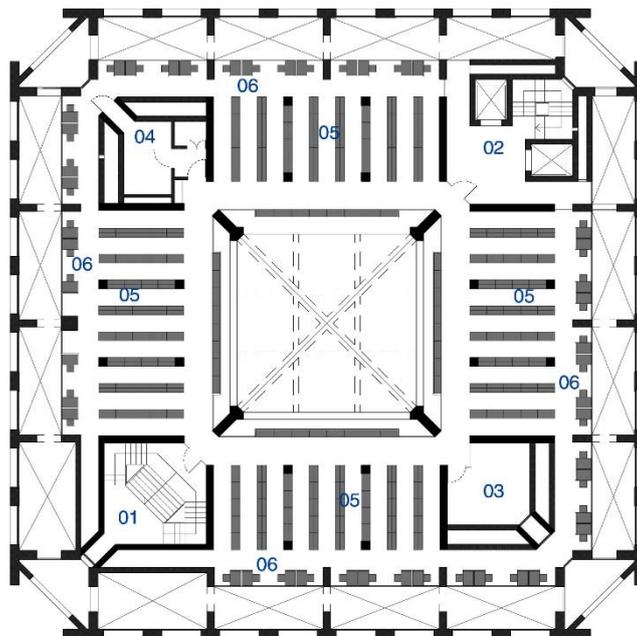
| Planta do quinto e do sétimo pavimentos (mezanino) [redesenho do autor]
